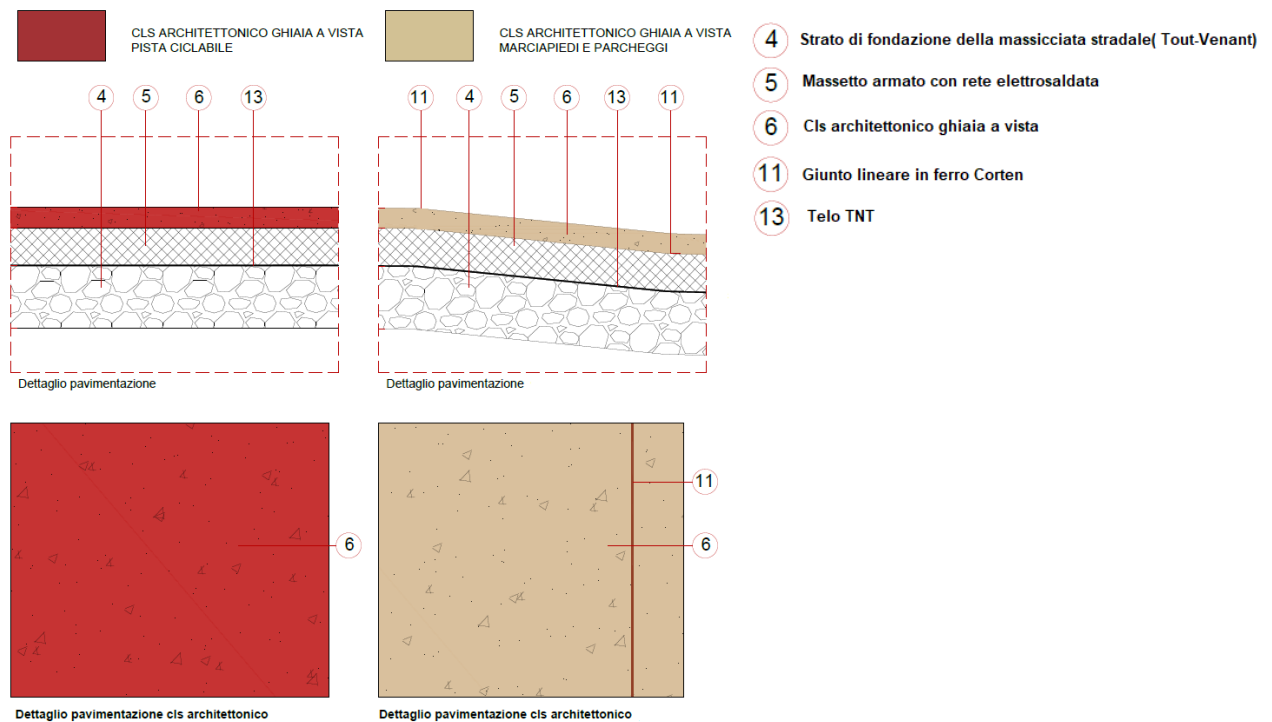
Particolari pavimentazione pista ciclabile, marciapiedi e parcheggi
